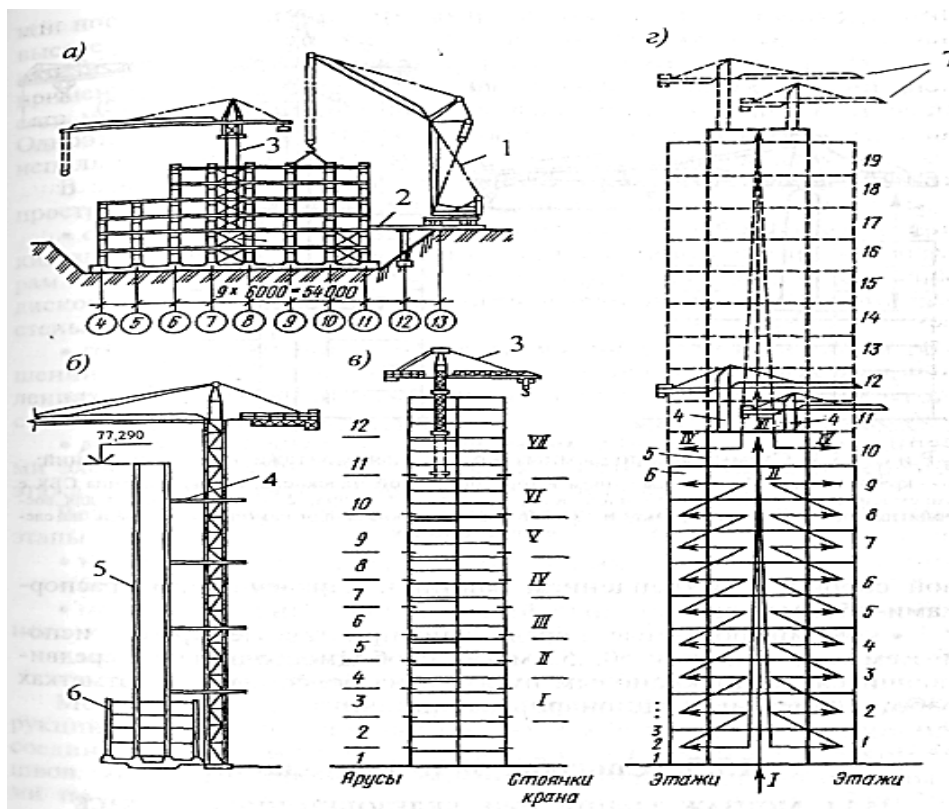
Схеми зведення висотних будівель: а - пересувним та самопідйомним кранами; б - приставним краном; в - самопідйомним краном; г - двома самопідйомними кранами; 1, 3, 7 - монтажні крани; 2 - шлях руху крана; 4 - монтажні зв'язки крана; 5 - ядро жорсткості; 6 - сталевий каркас; I...VII- етапи робіт
